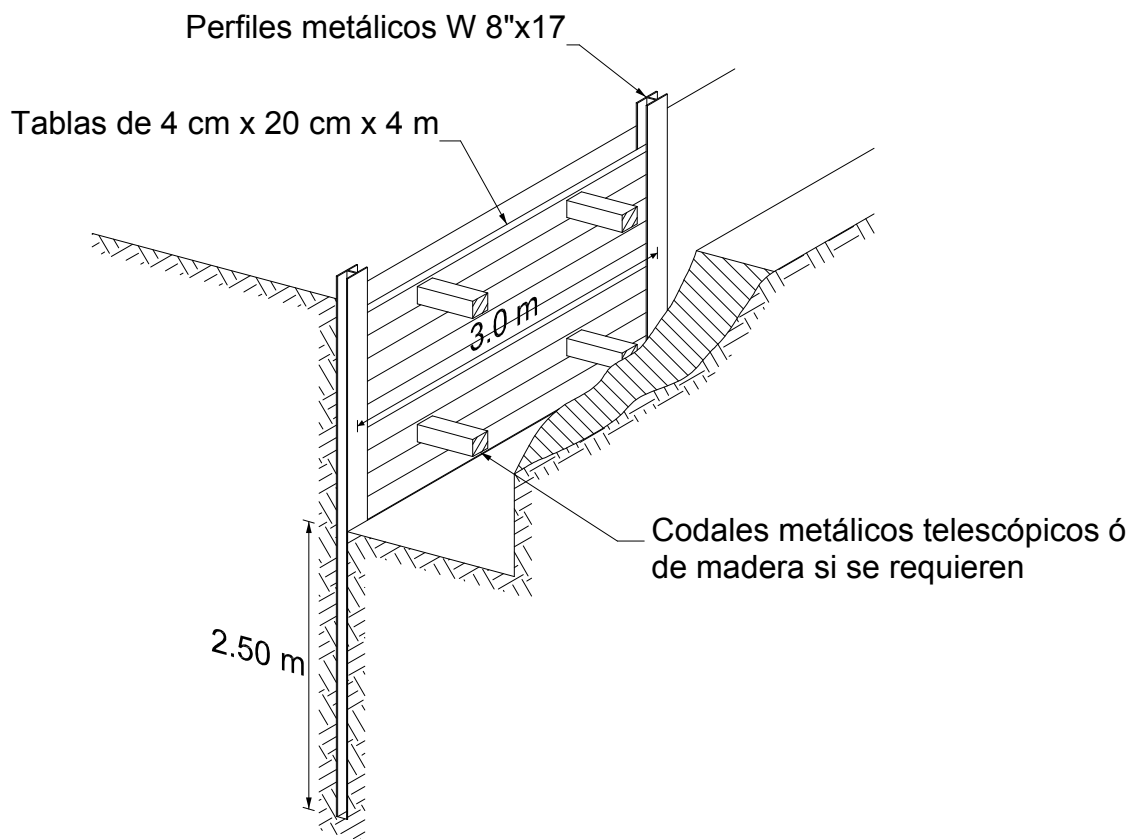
Esquema típico de Entibado Tipo 2 alternativo
